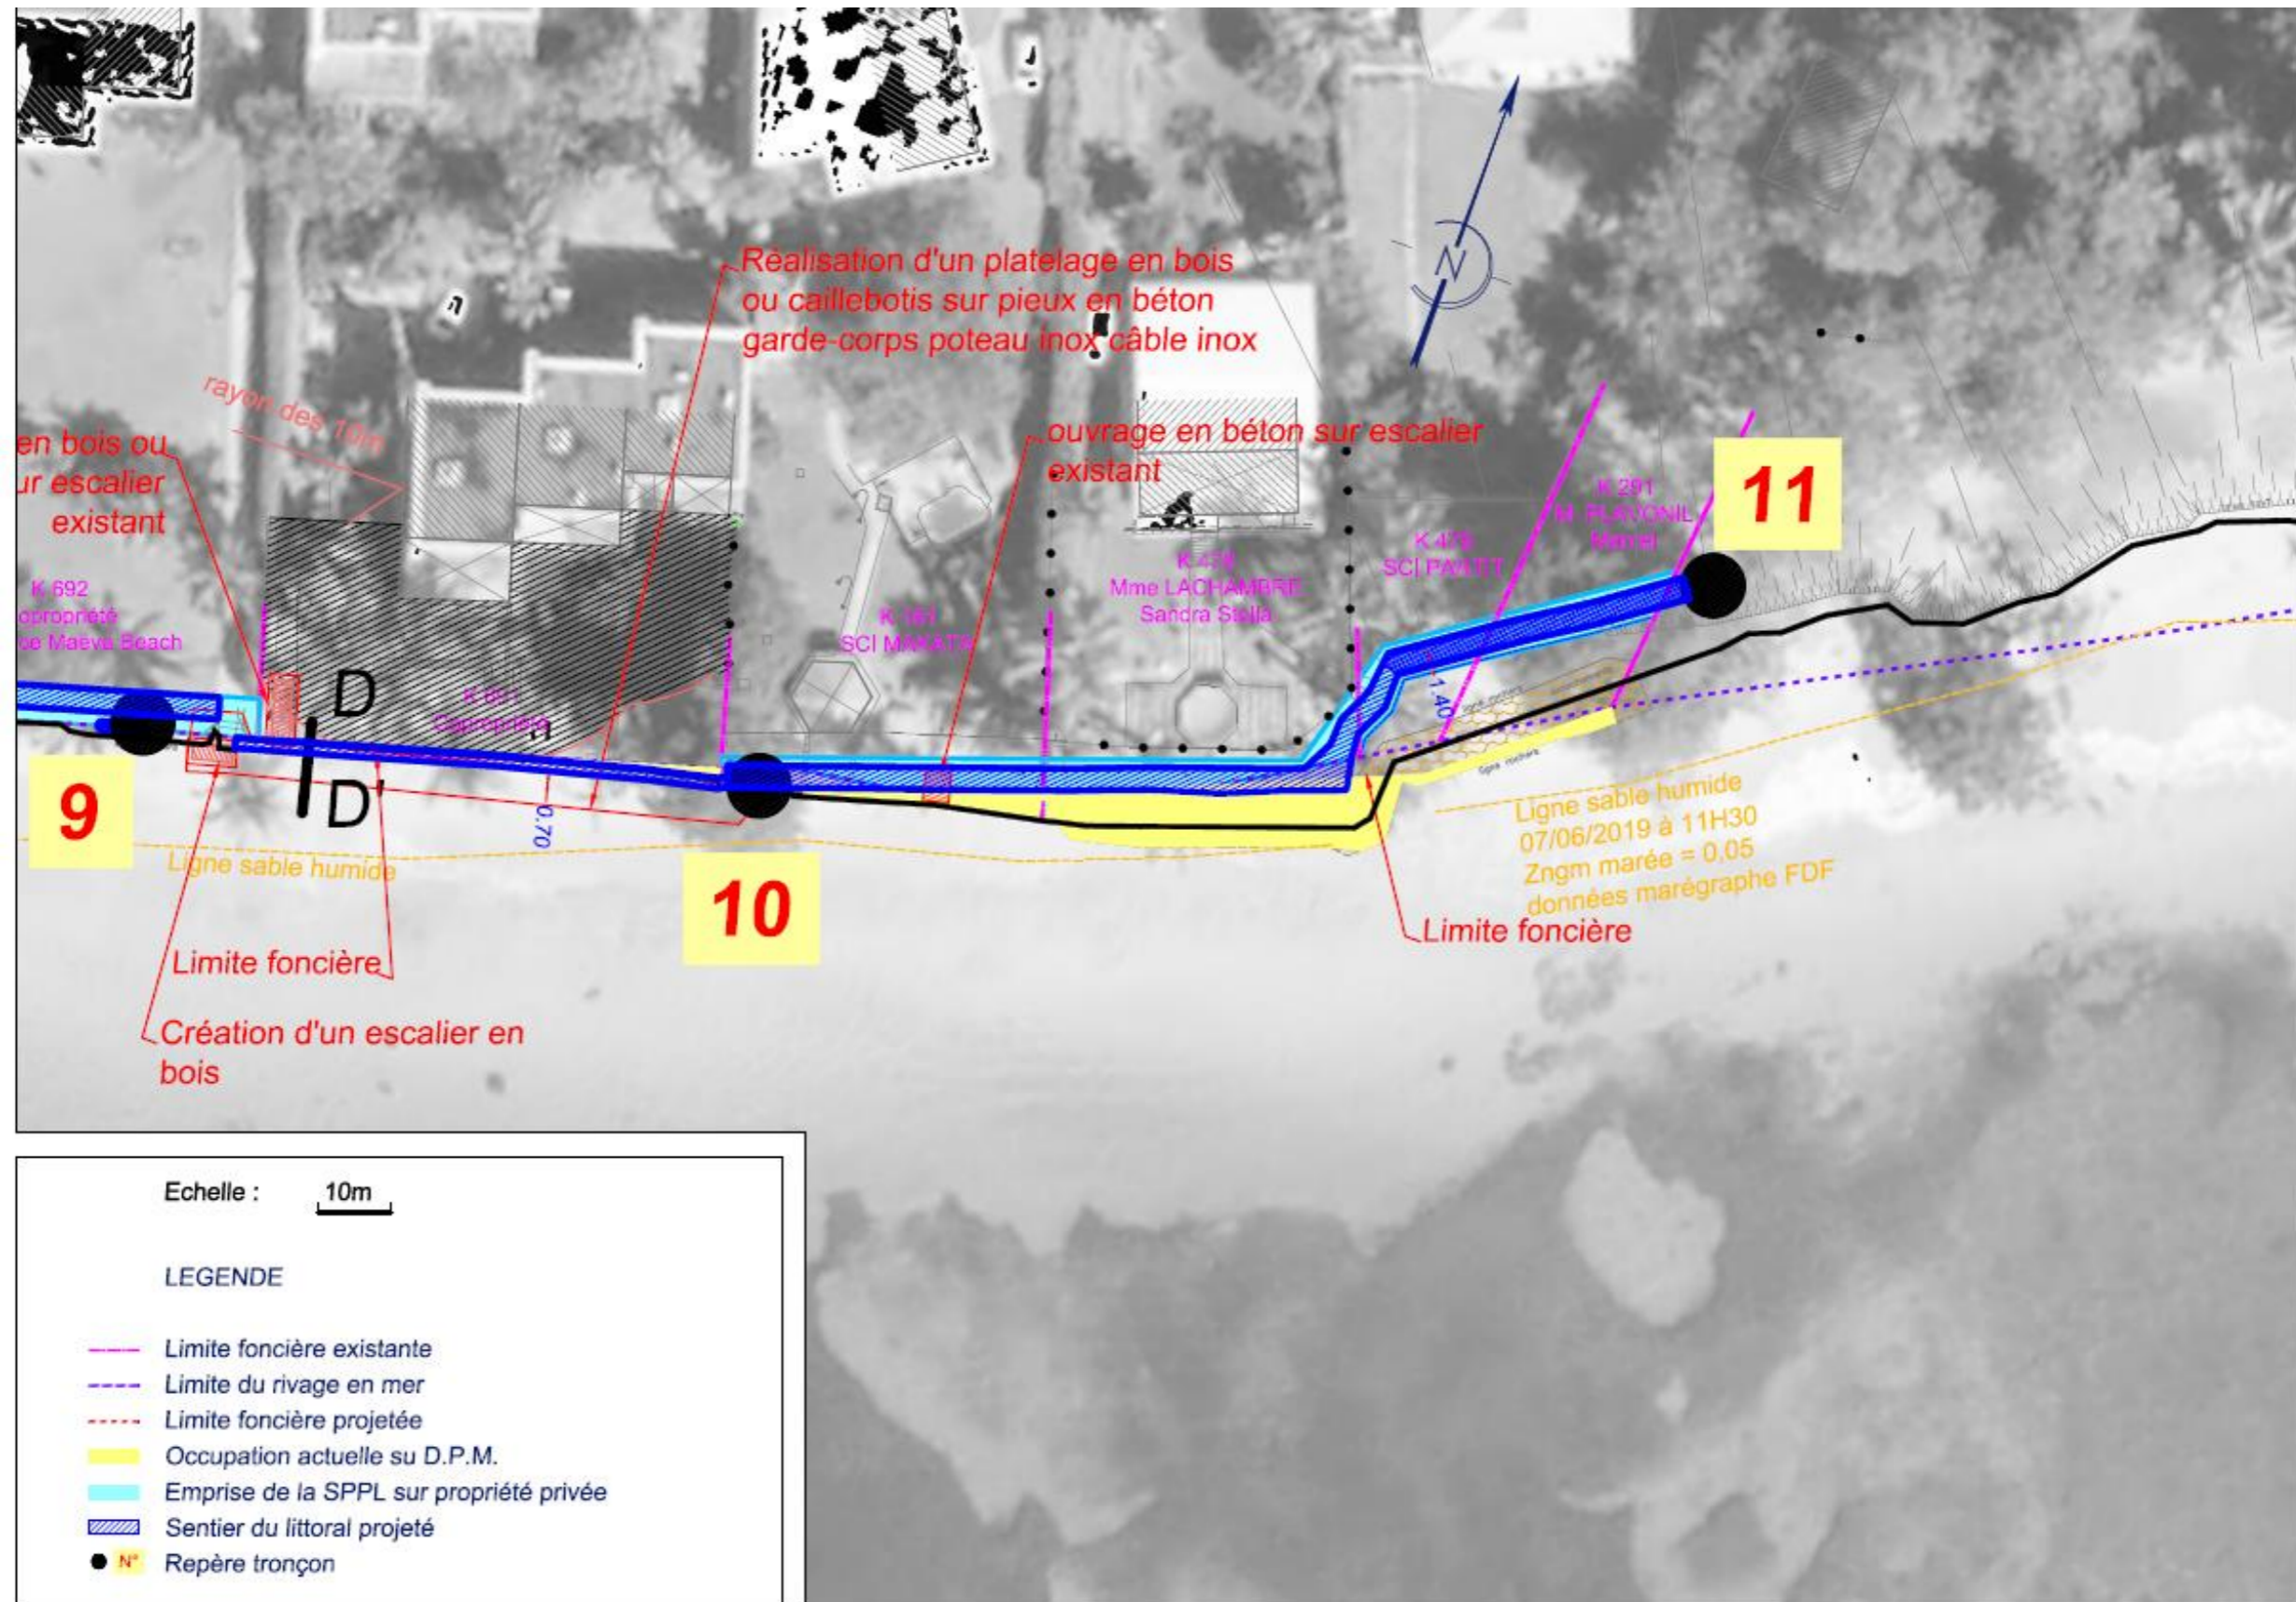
Tronçon 10-11 (Source : Suez consulting, 2021)
